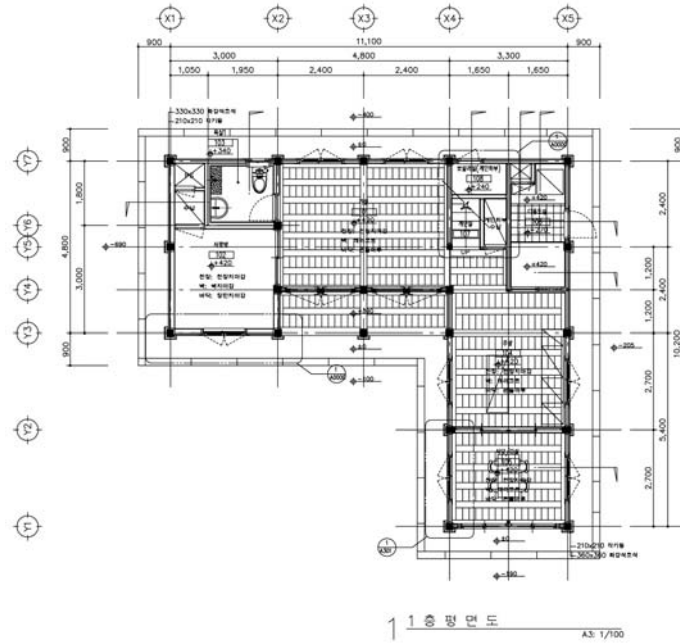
시범한옥 1층 평면도 (2-2 세세부 제공)
